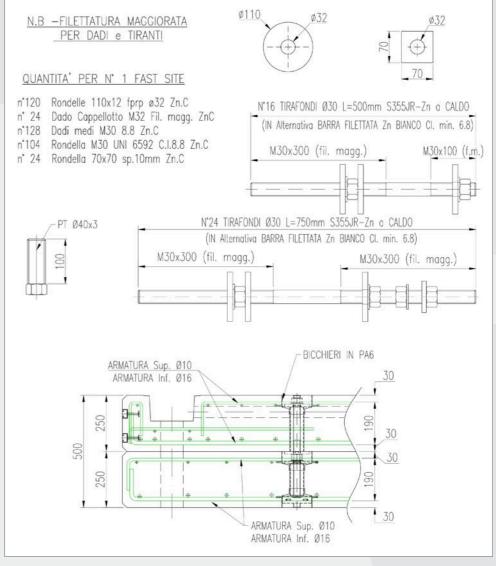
Collegamento moduli FAST SITE® SYSTEM 18
